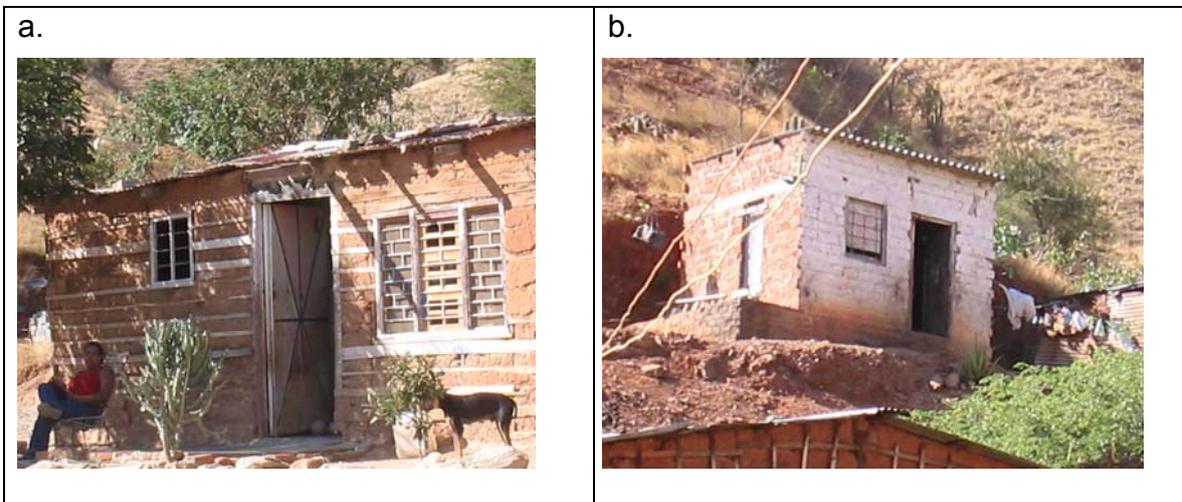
Calidad de las Viviendas por materiales de construcción en Cerro Norte. a.) Vivienda construida en barro. b.) Vivienda construida en mampostería.
